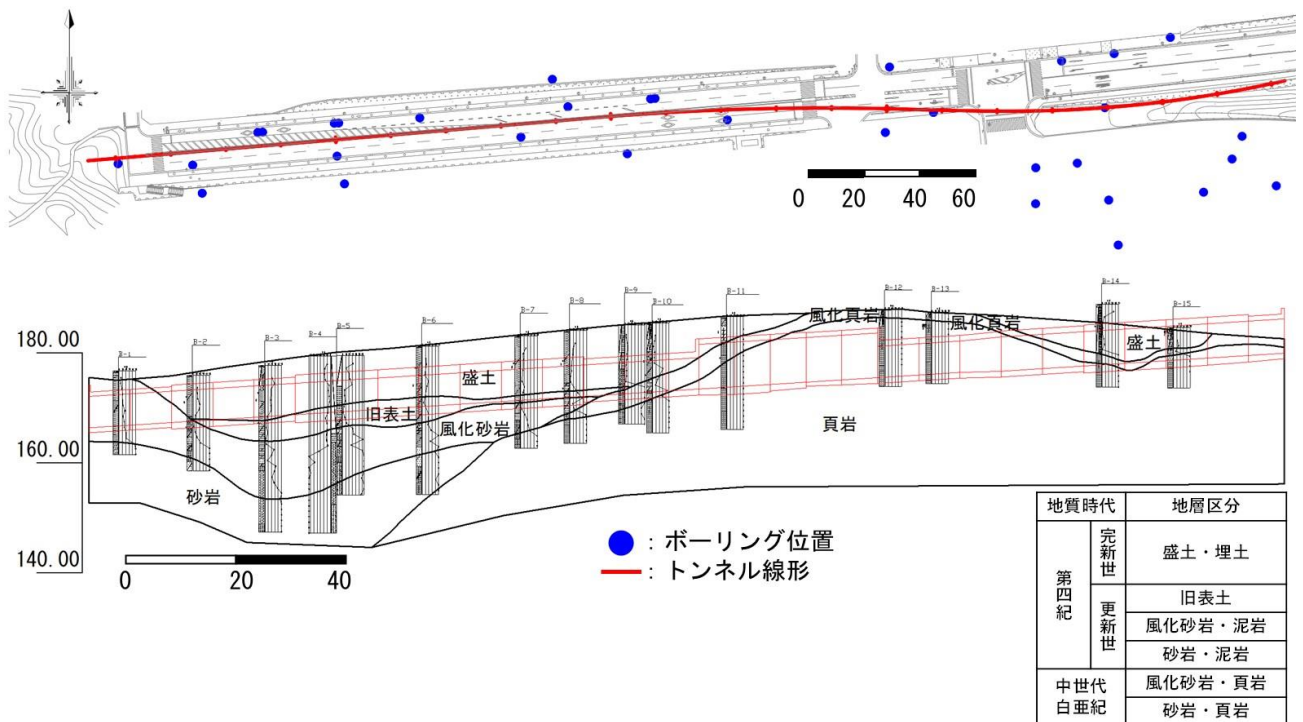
対象地の地盤状況(上段:平面図, 下段:断面図)
